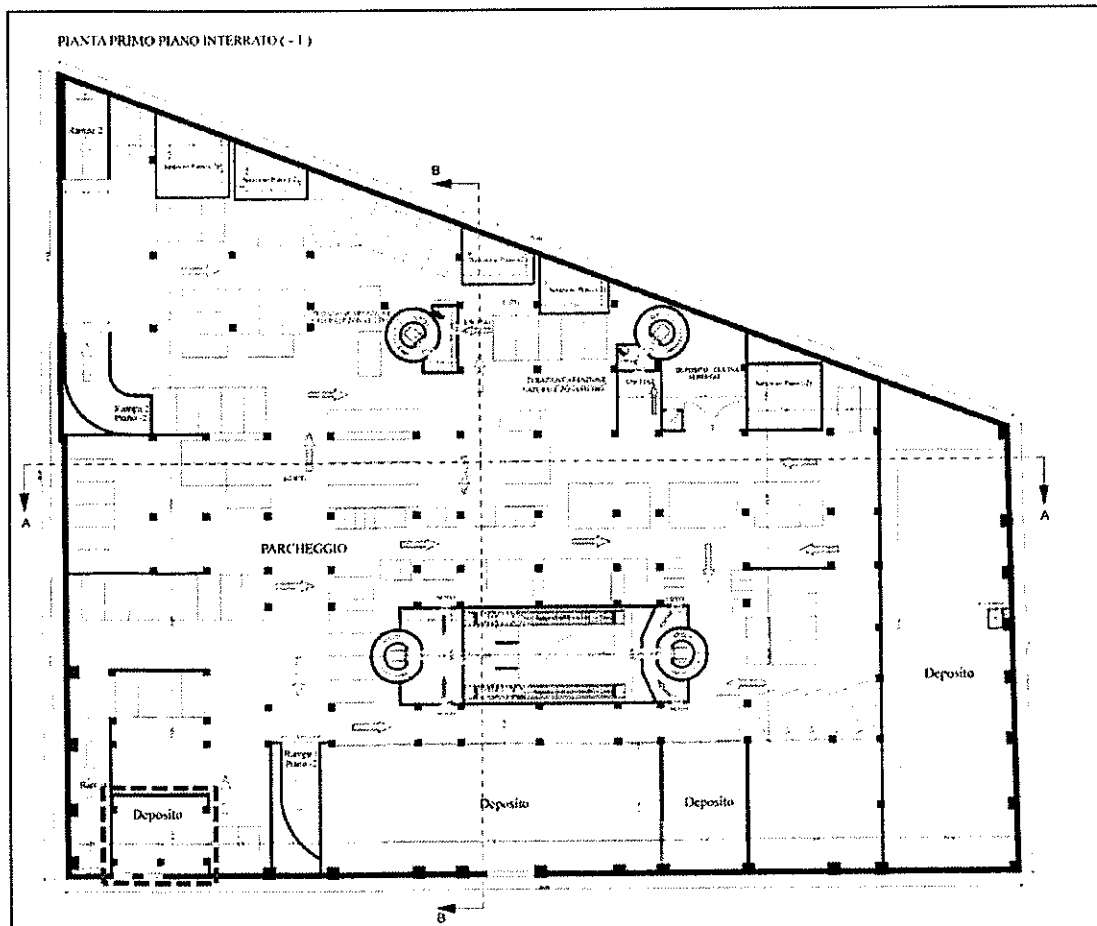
Progetto del piano primo interrato estratto dalla tavola allegata al PdC n. 59/2013.
